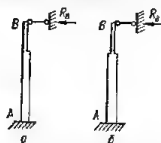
Расчетные схемы стоек многопролетных поперечников при действии вертикальных и крановых нагрузок:
